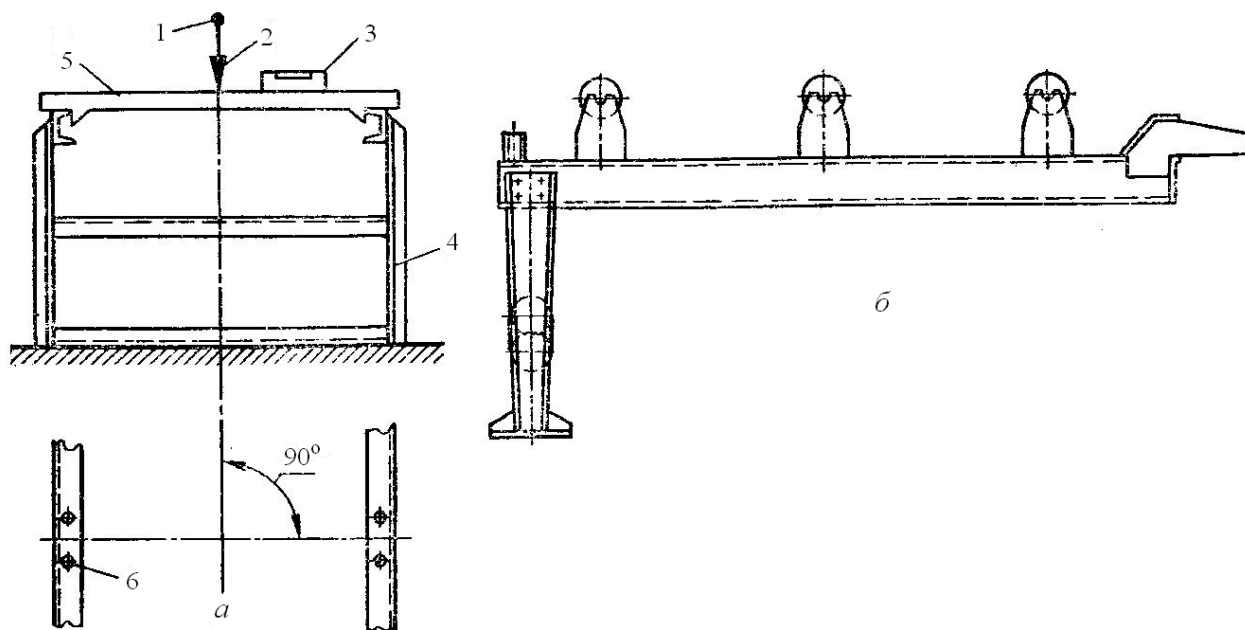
Схема подготовки металлоконструкции к монтажу:
